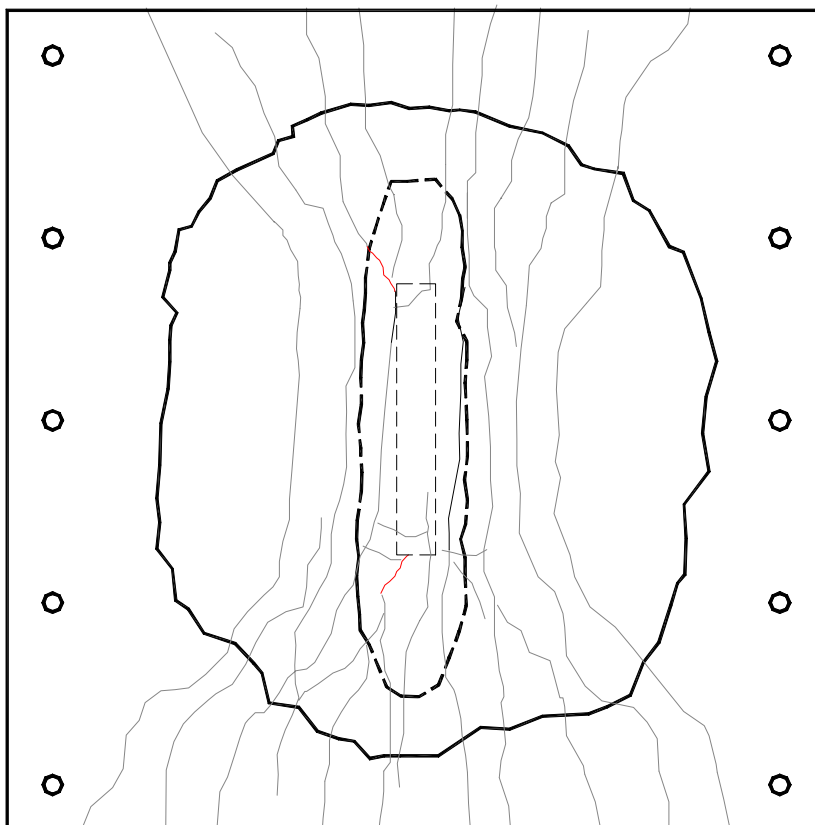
Mapa de fissuração da laje L4A
